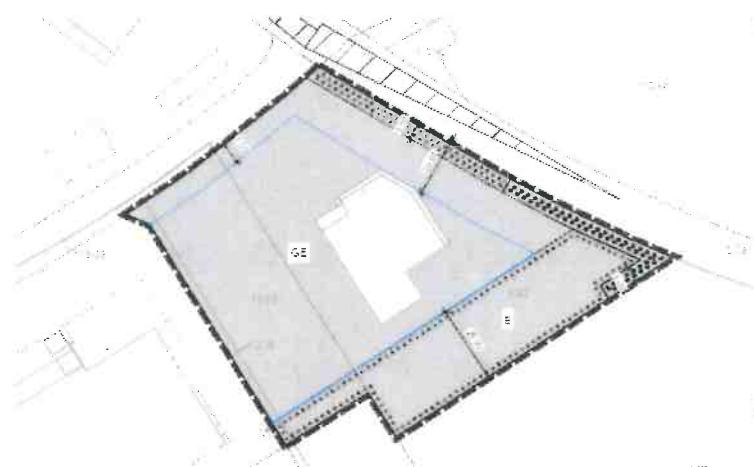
; Plangebiet mit Angaben zum Gehölzerhalt am Nordostrand (dunkle Markierung)
